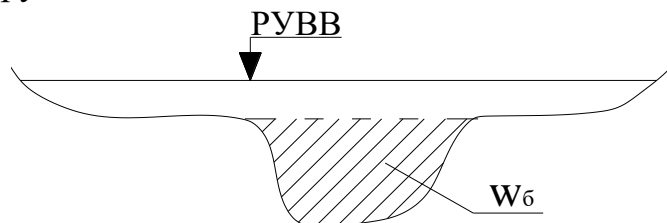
Схема к определению площади поперечного сечения канала
